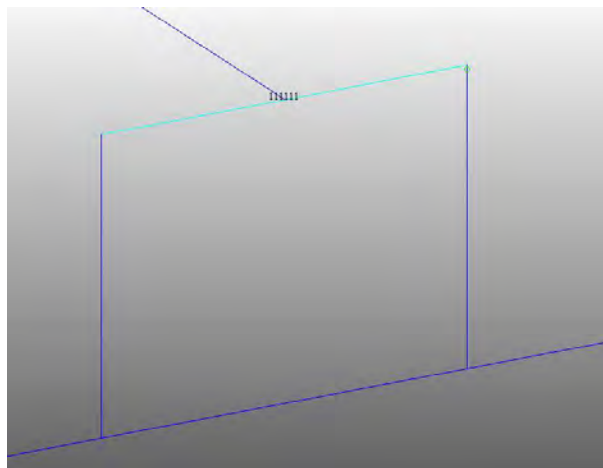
Particolare della modellazione del tegolo: il tegolo collegato alla trave tramite un Beam e un Truss
